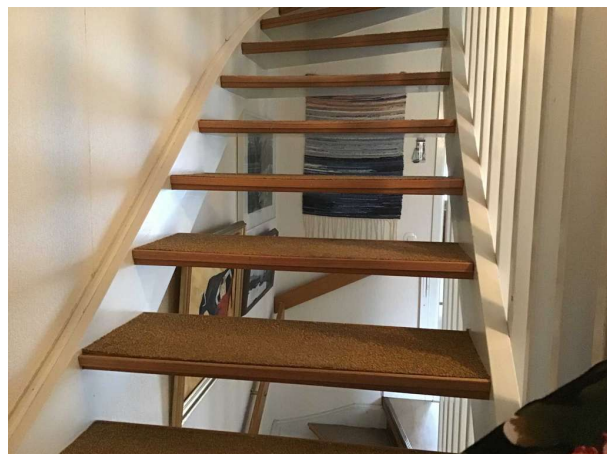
Entréplan, Trappen bedöms ej vara barnsäker då avståndet mellan trappsteg bedöms vara större än 10 cm.
